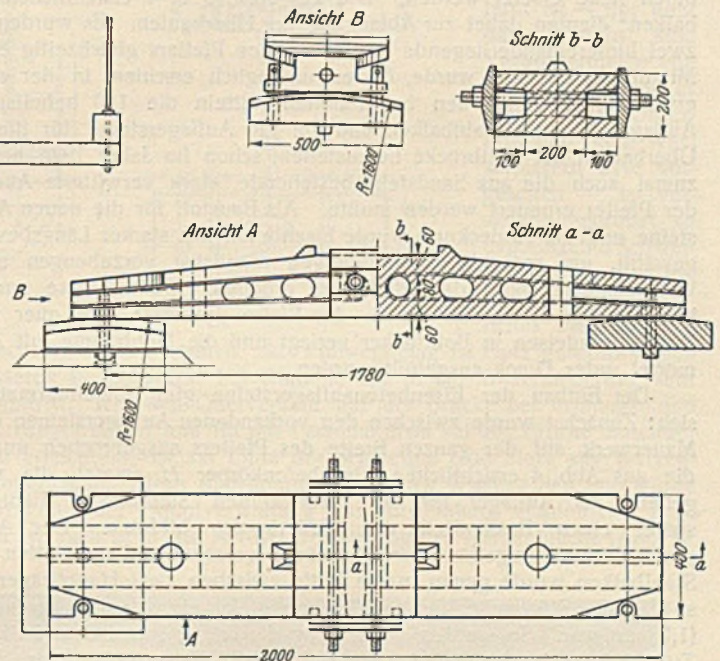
Stahlbalken zur behelfsmäßigen Abfangung der alten Überbauten.
